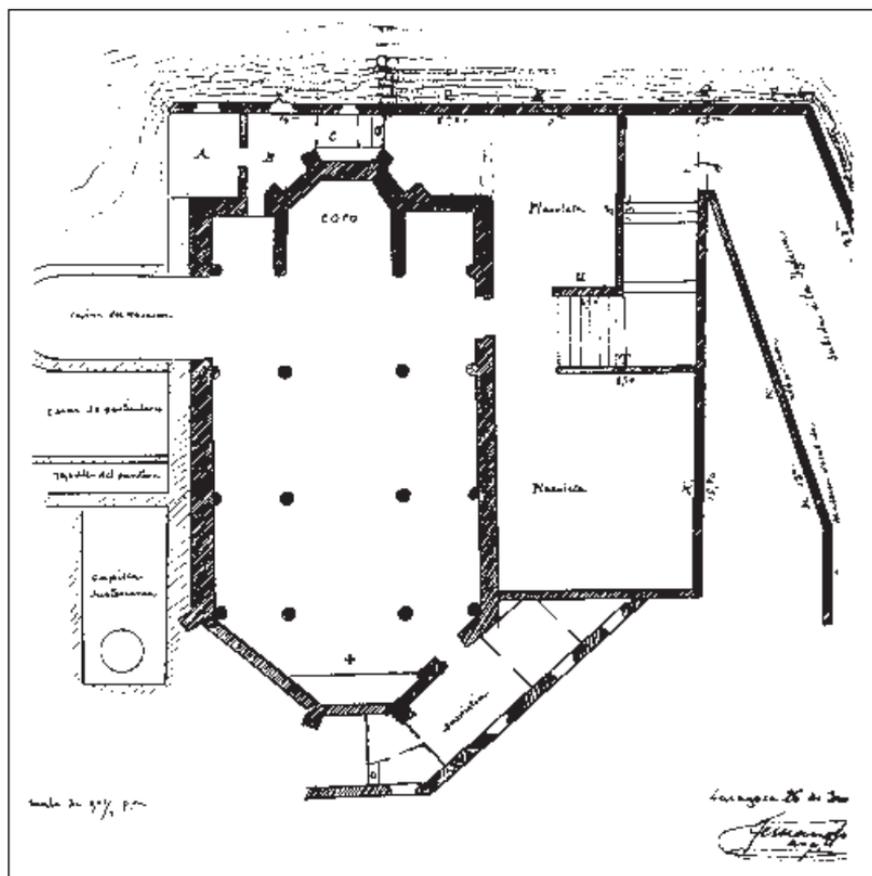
Planta del proyecto de restauración del arquitecto D. Fernando de Yarza (1883).
